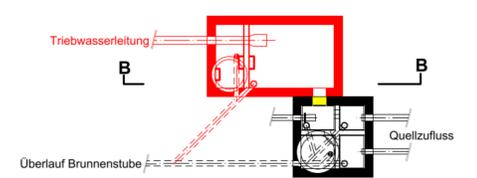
Grundriss und Schnitt des neuen Krafthauses auf dem Dach des bestehenden Reservoirs
